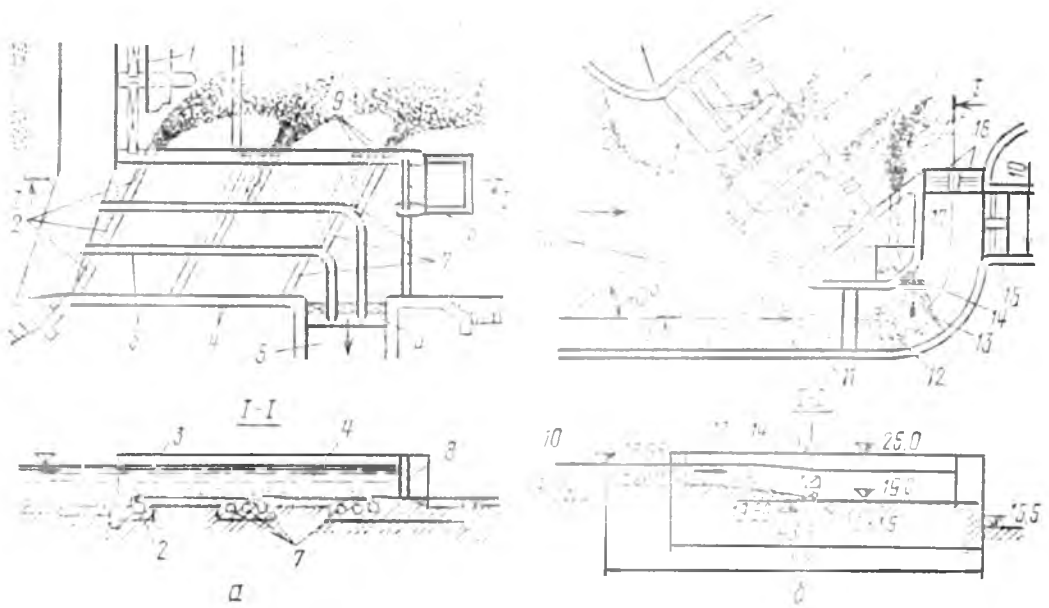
Фронтальный водозаборный гидроузел с карманами:
